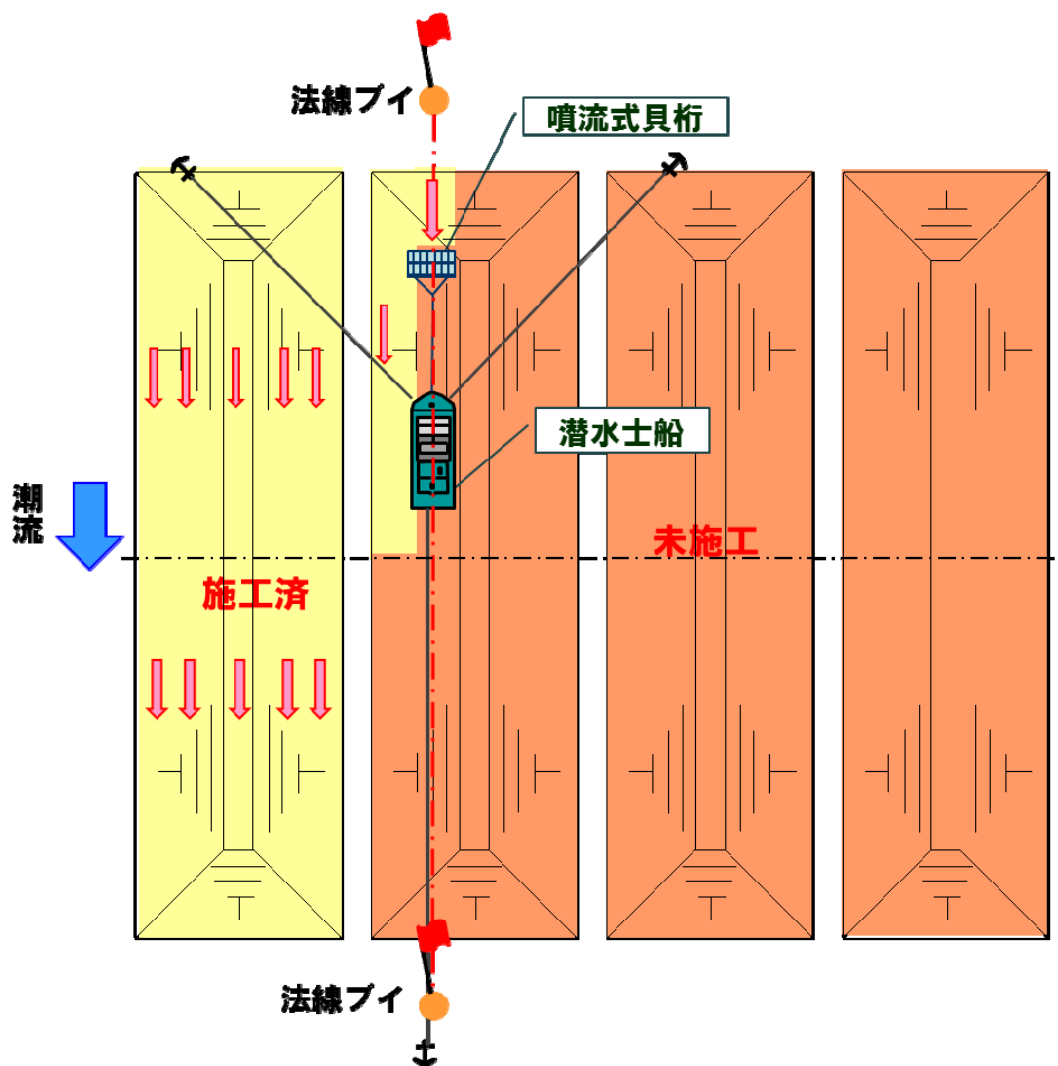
噴流式貝桁を用いたメンテナンスの施工状況平面図
